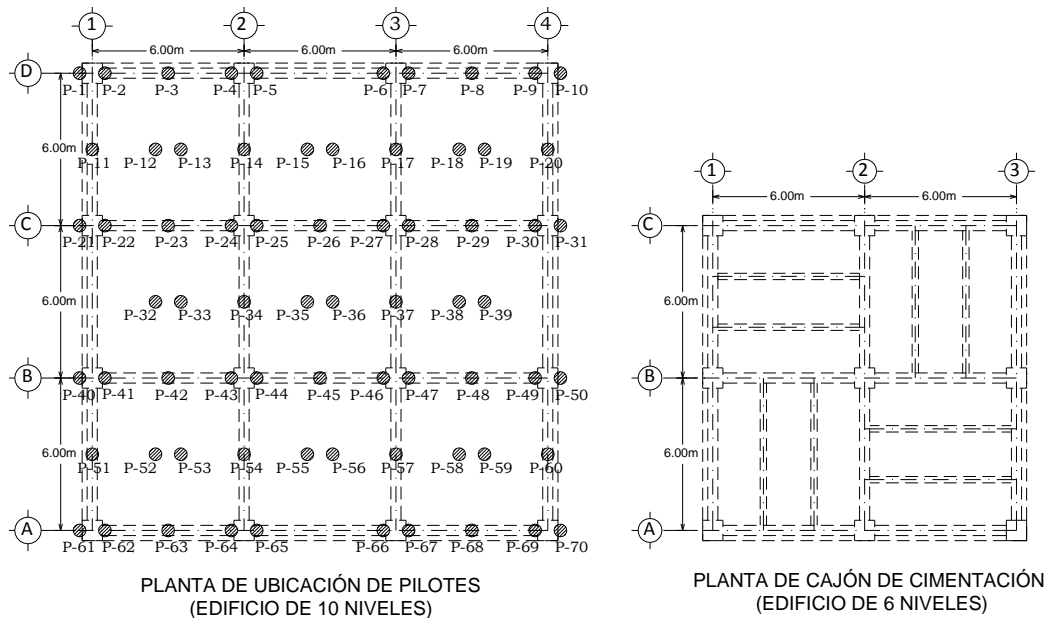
Cimentación con pilotes (Edificio 10 niveles) y cajón de cimentación (Edificio 6 y 10 niveles).
